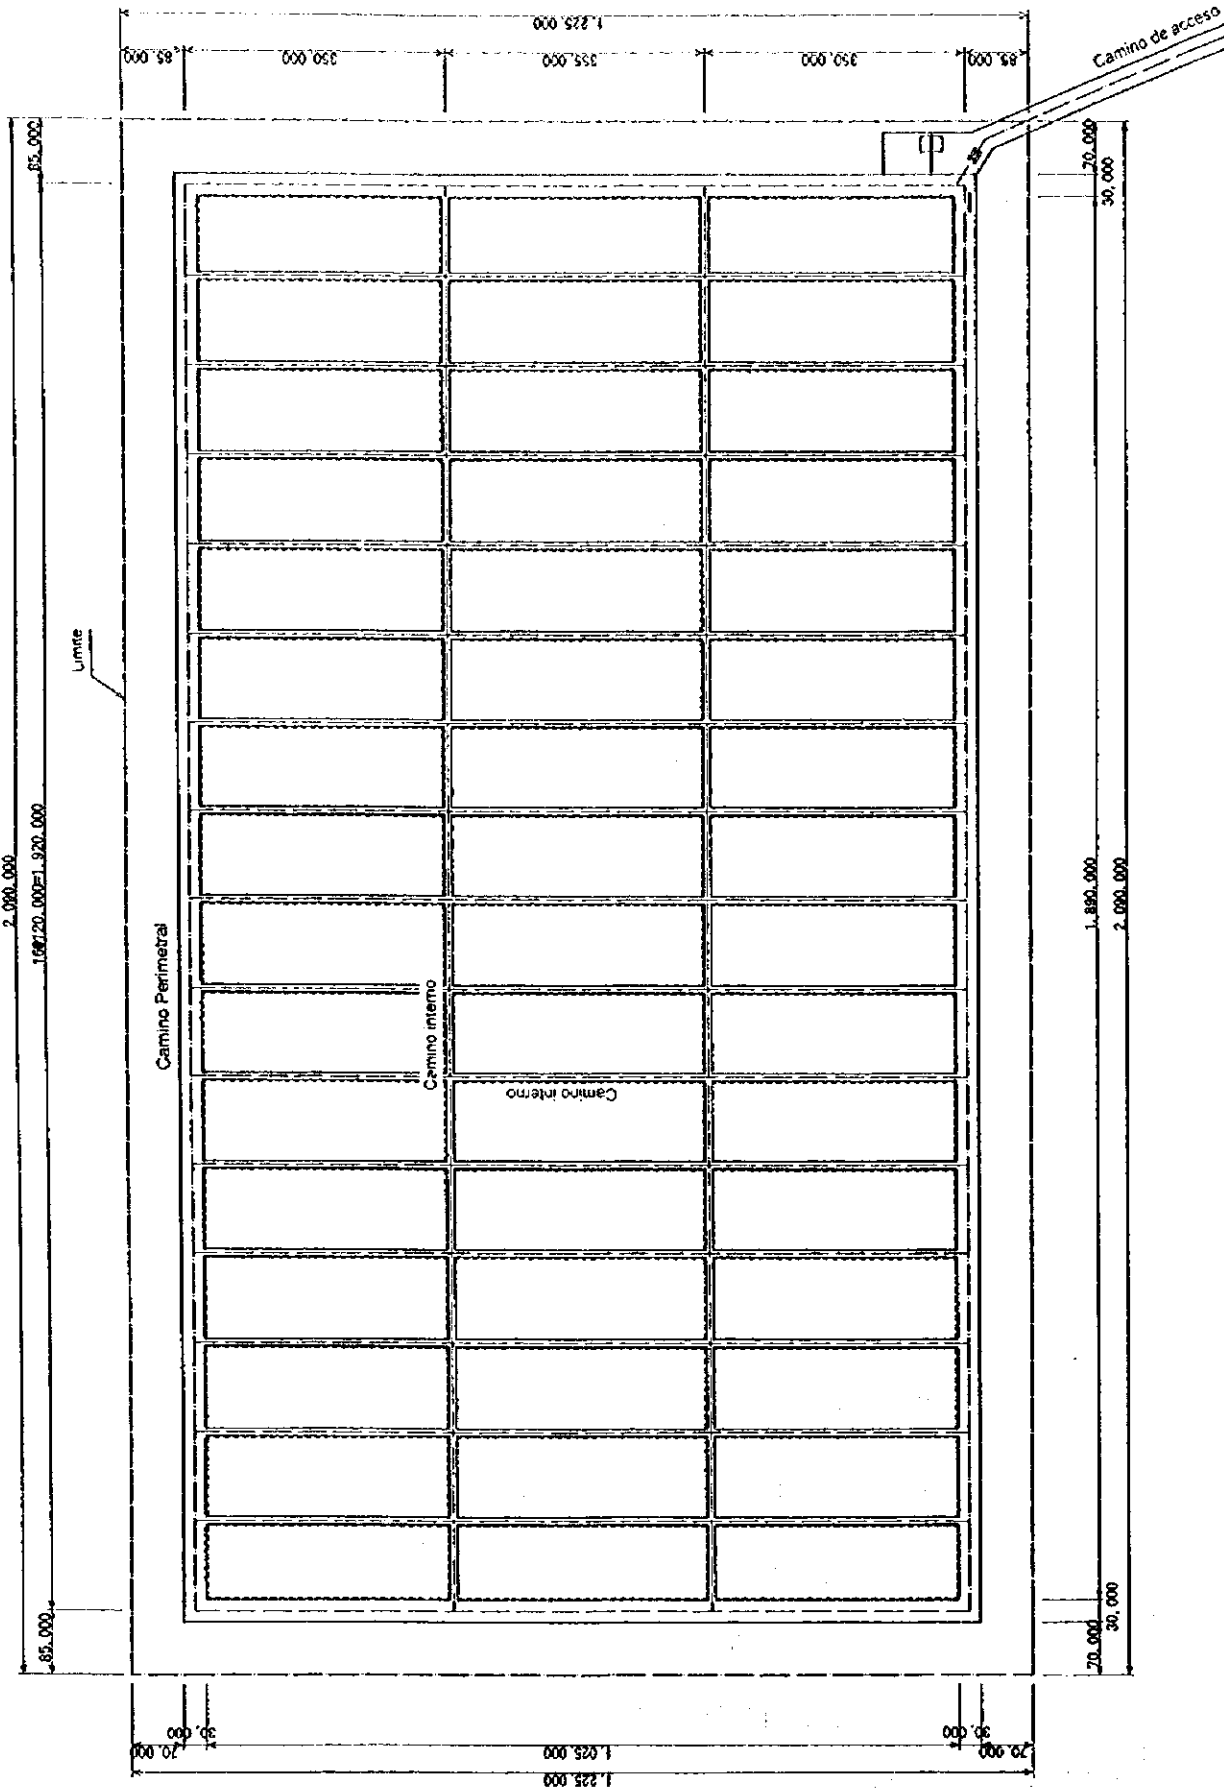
Plano de Planta del Primer Nivel (0 m. de elevación)
